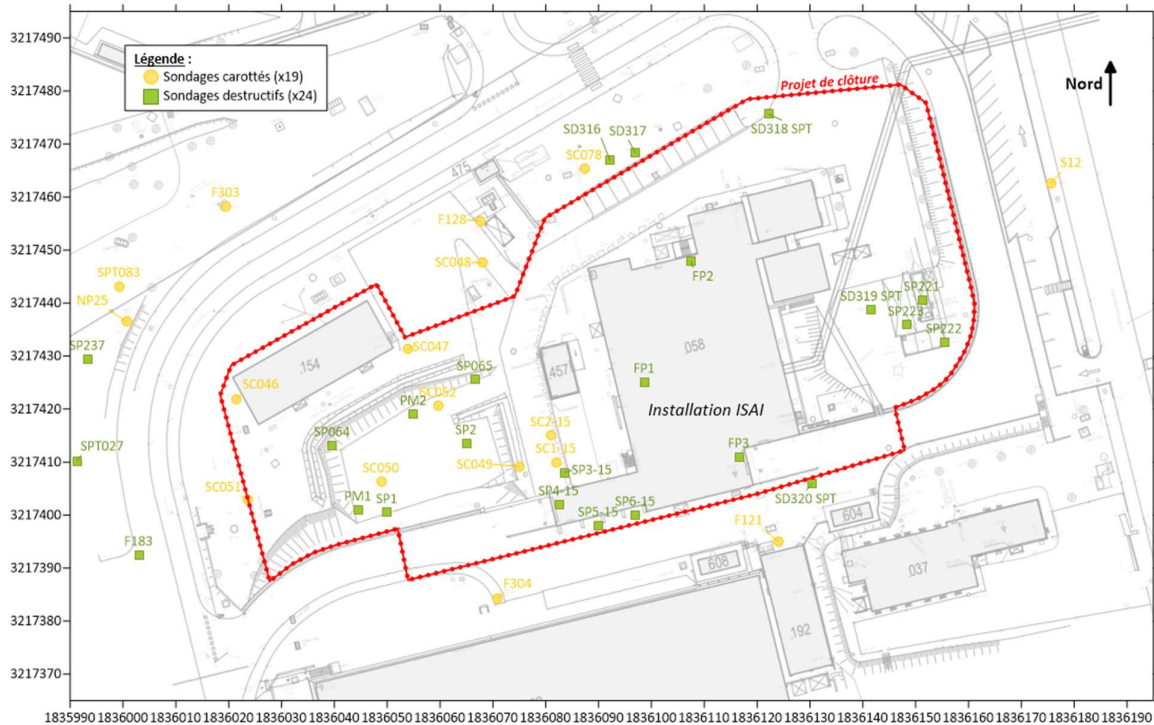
Plan d'implantation des sondages d'archives par type de forage
